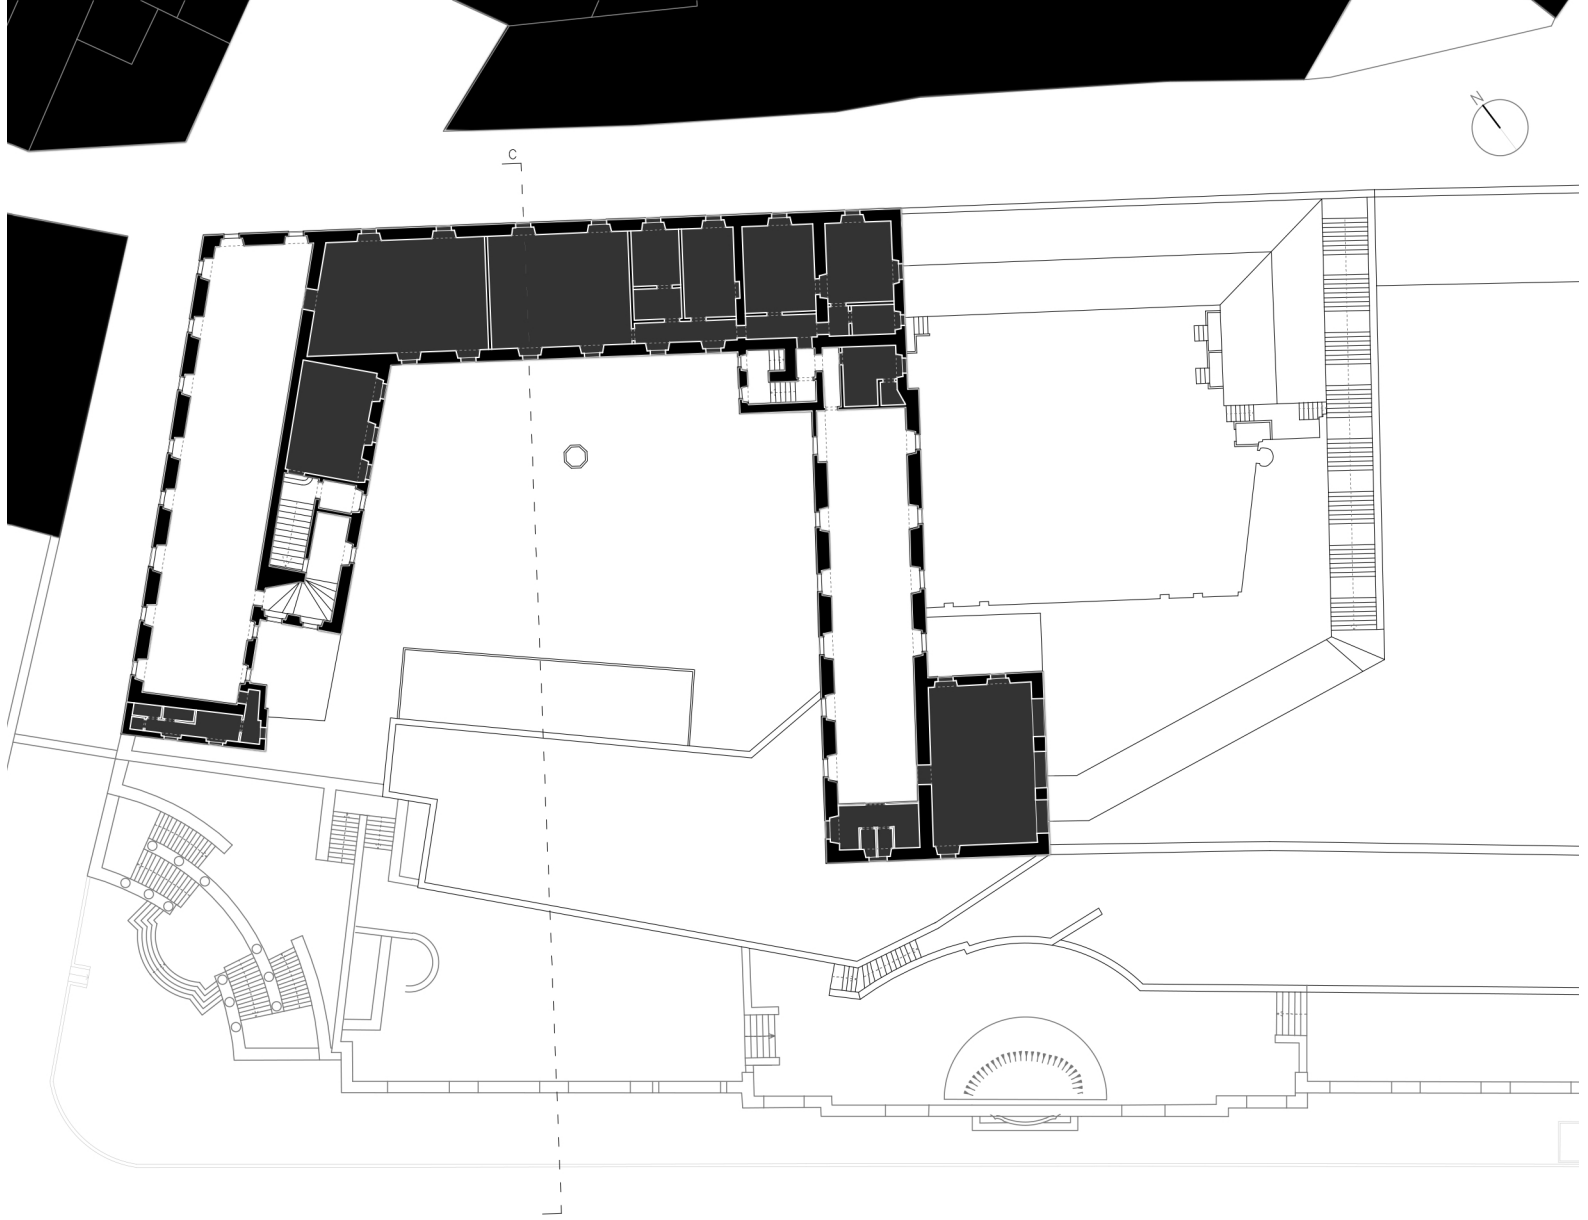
Planta do piso 2 e Corte Transversal C | 1:500
